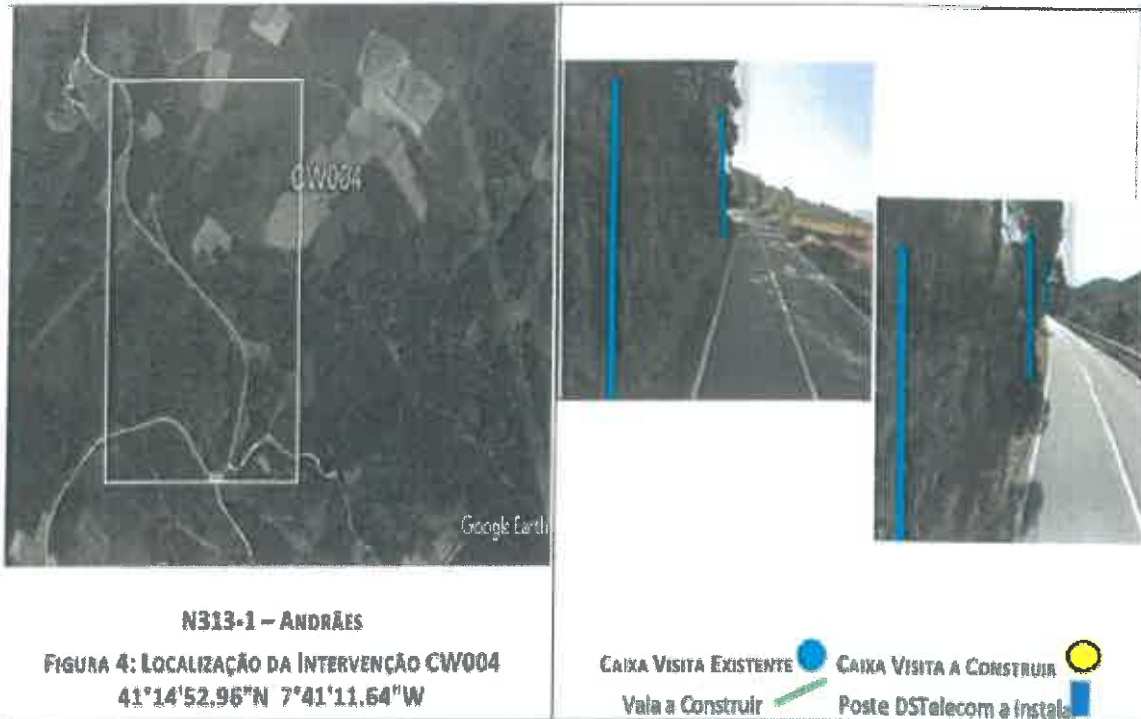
N313 – Andrães – Implantação de 16 postes DST em betão.
